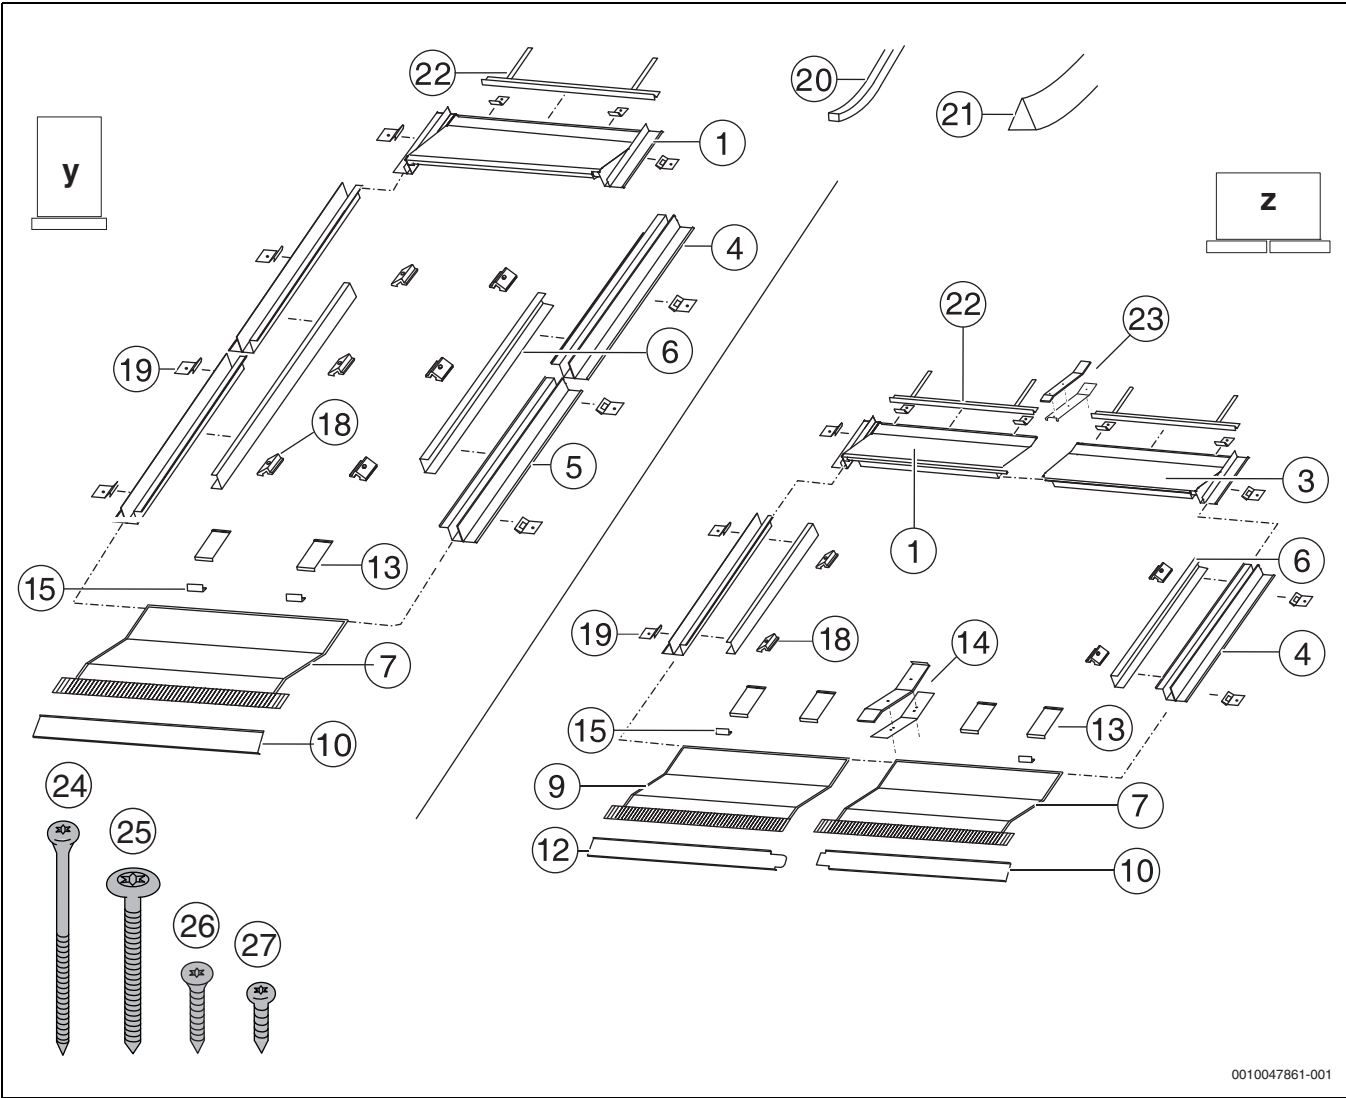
Set di fissaggio/montaggio per 1 collettore verticale (a sinistra) e orizzontale (a destra)
